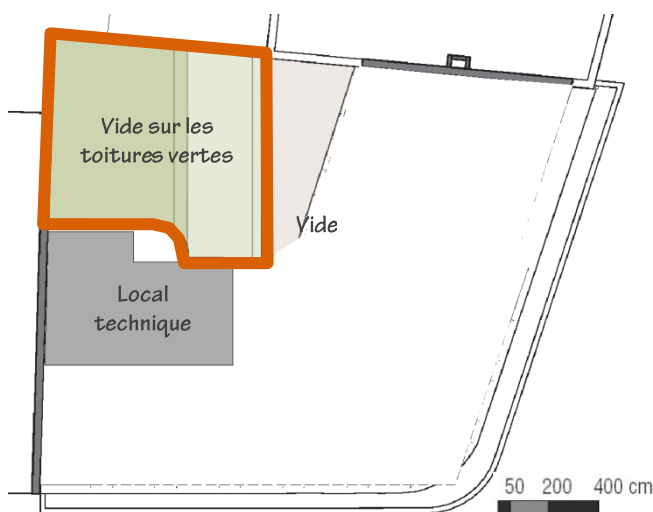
Plan du local technique et du toit (Source : Bureau A2M, 2011)
